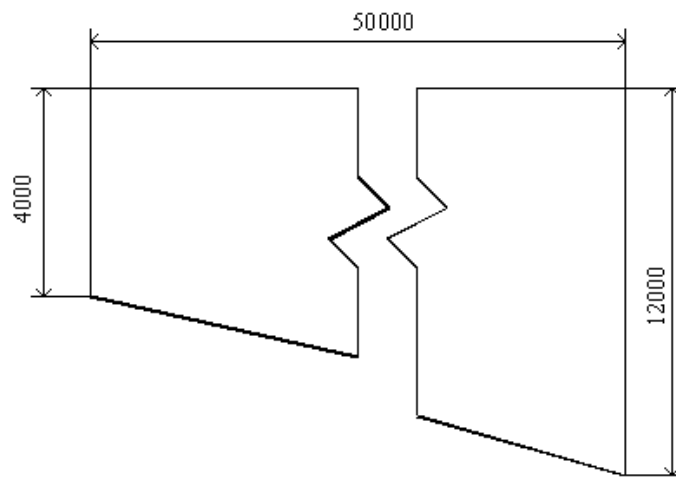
Поперечный разрез помещения с амфитеатром к задаче 1.3.13
